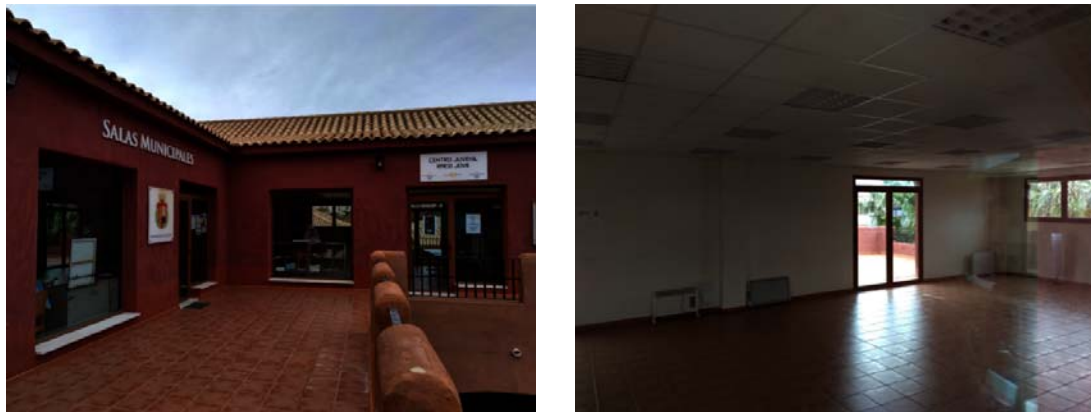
Fachada de mampostería con acabado enlucido exterior e interior
